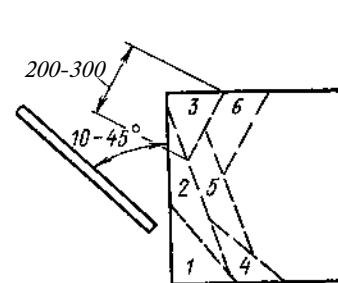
Схема резки «участками» бетона и железобетона толщиной более 200 мм
